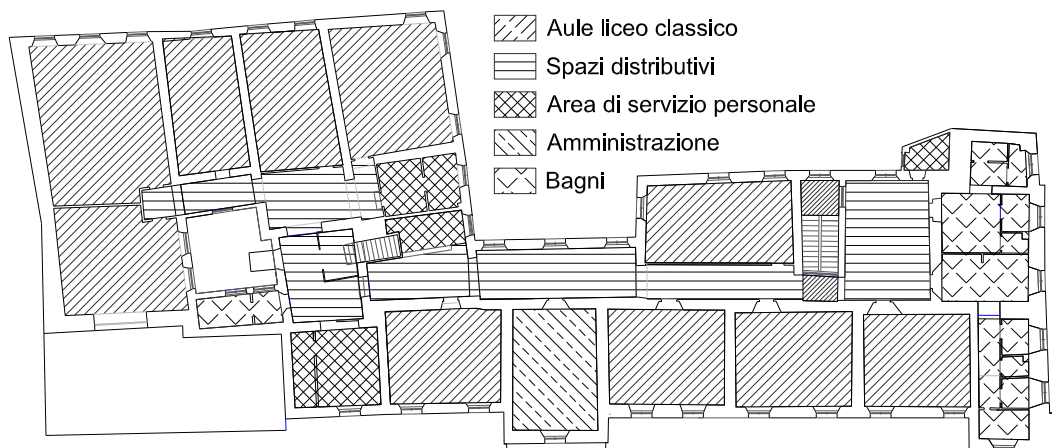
Destinazione funzionale piano ammezzato
